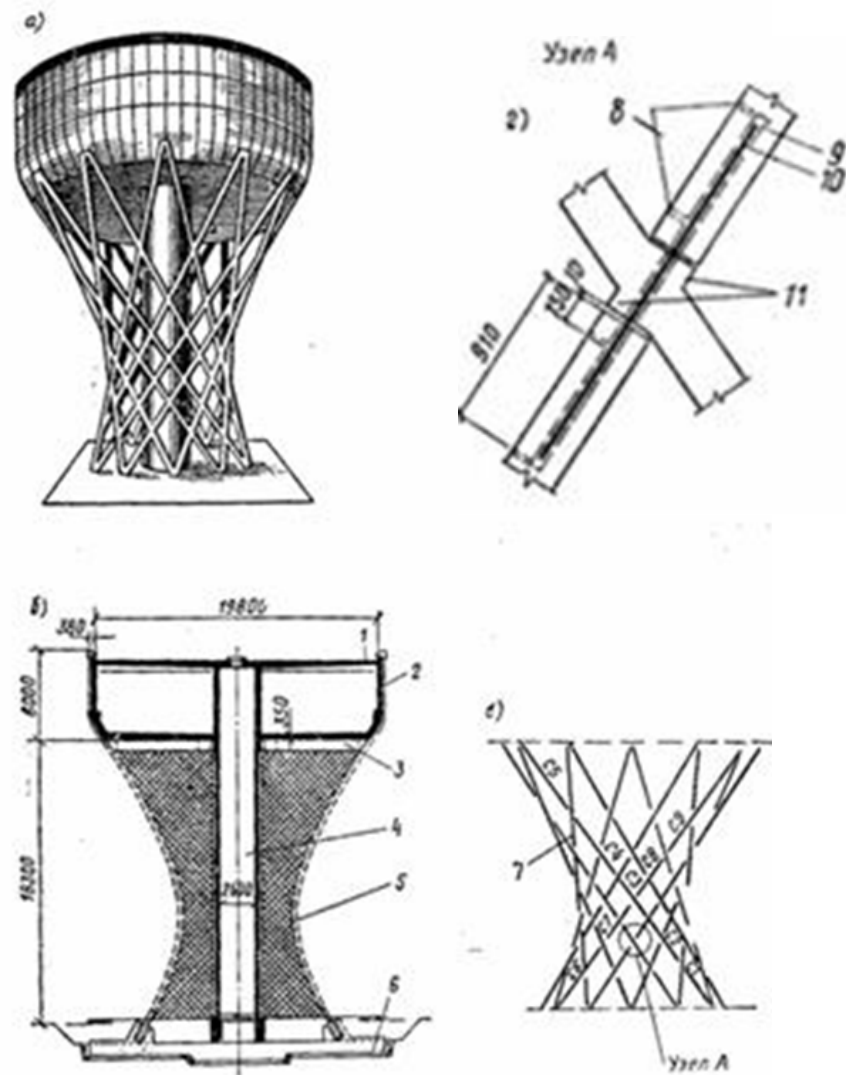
Водонапірна башта з опорою комбінованої конструкції: а – загальний вигляд; б – вертикальний розріз; в – монтажна схема решітчастої частини опори; г – стик збірних елементів нахилених ніг; 1 – покриття резервуара; 2 – стінка резервуара; 3 – днище резервуара; 4 – центральна циліндрична частина опори; 5 – решітчаста частина опори; 6 – фундамент; 7 – ноги; 8 – отвори для нагнітання розчину; 9 – гніздо; 10 – сталевий штир; 11 – двохсторонні виступи ніг
